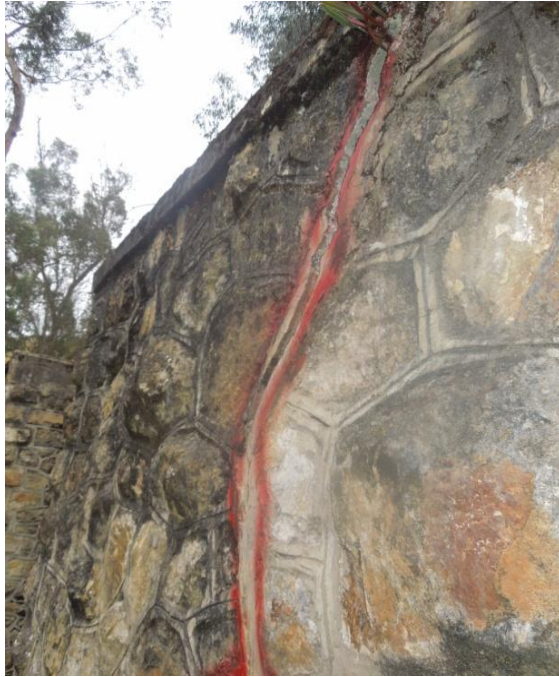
Arco #1. Detalles fisura A1F2
